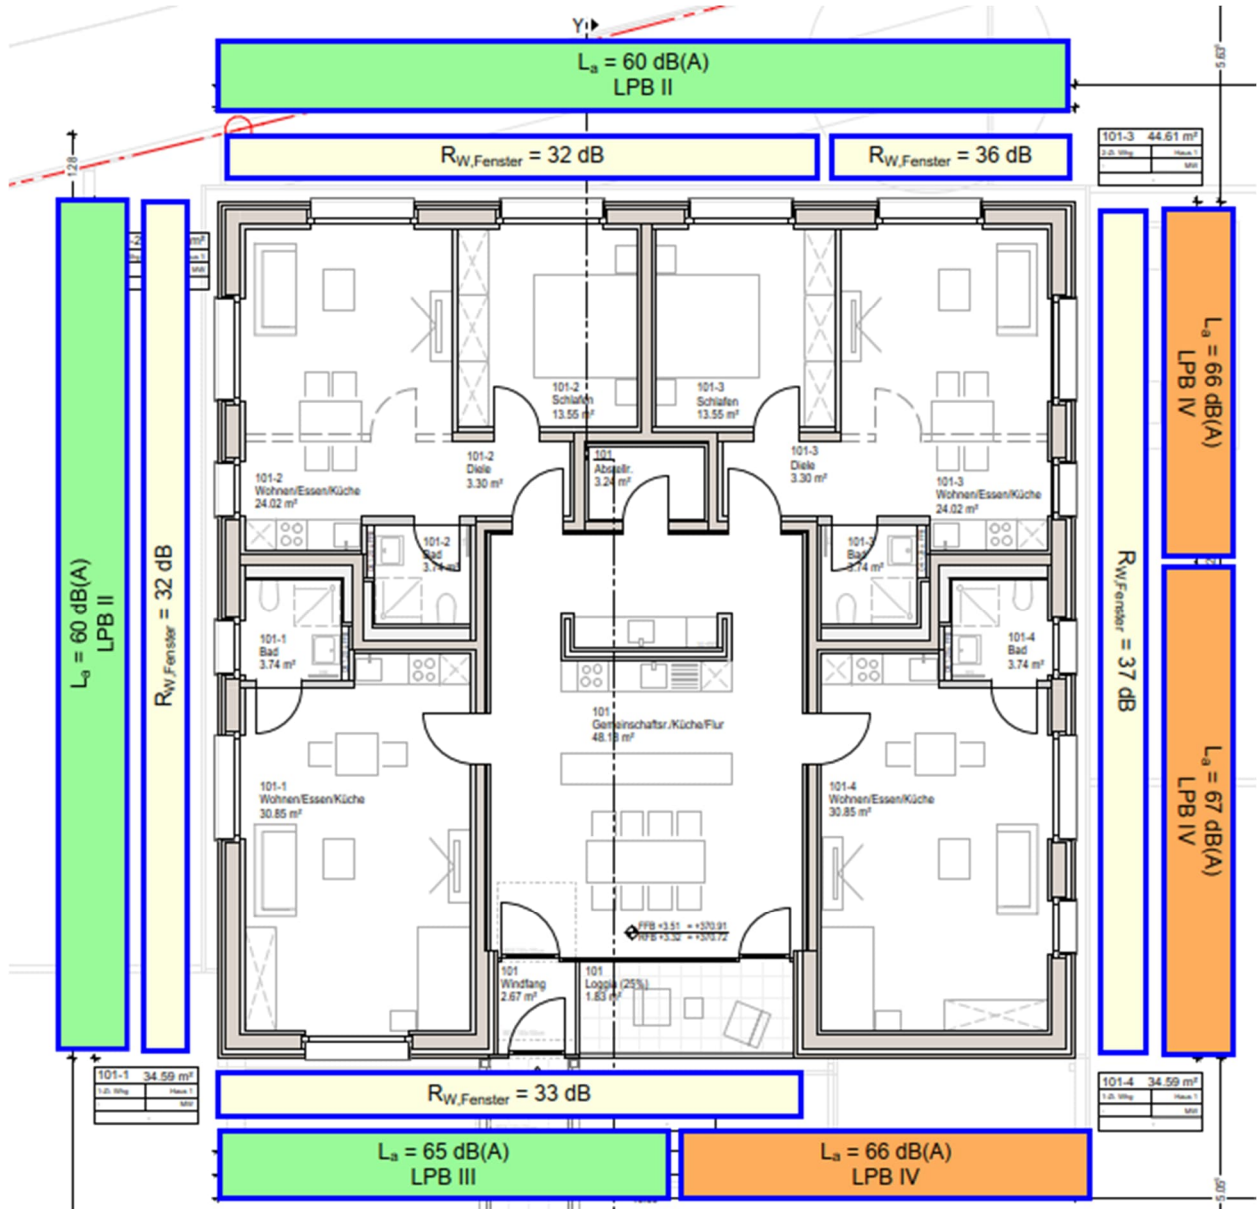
Außenlärm – Grundriss 1.OG – Haus 1
